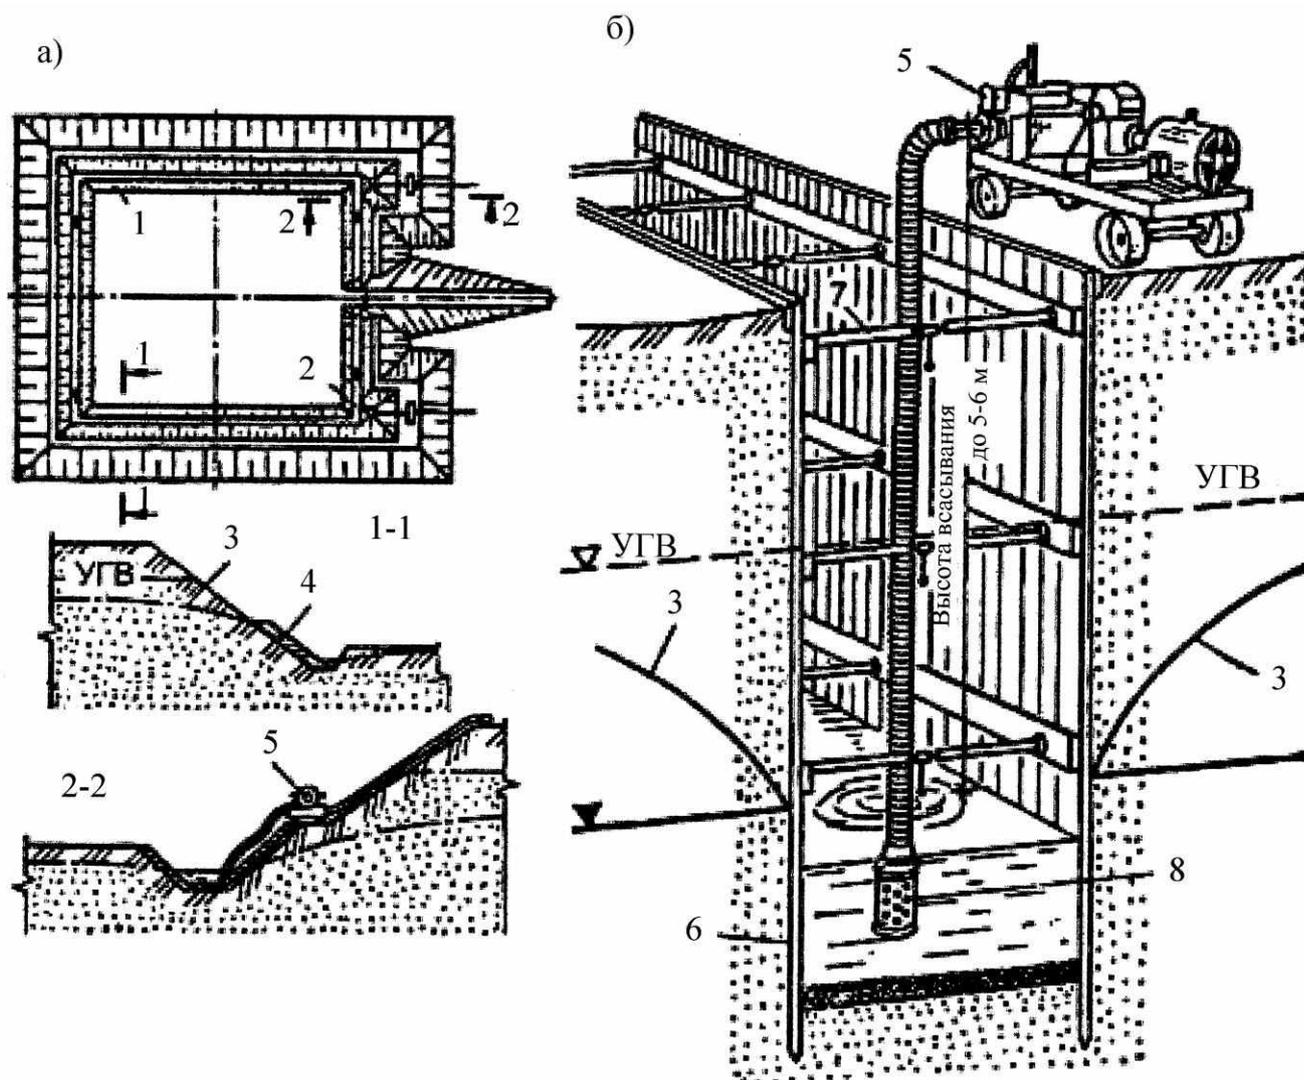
Открытый водоотлив из котлована (а) и траншеи (б)
